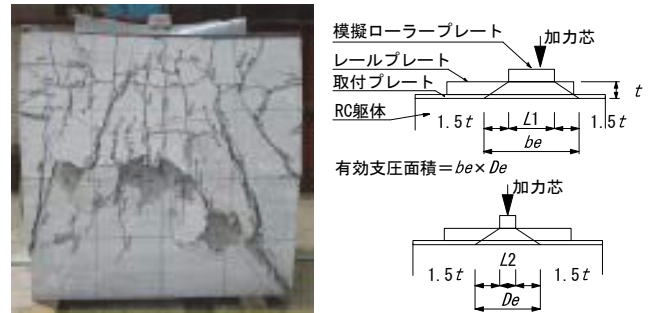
試験後の状況 (No. 2) 図-11 支圧面積の考え方
